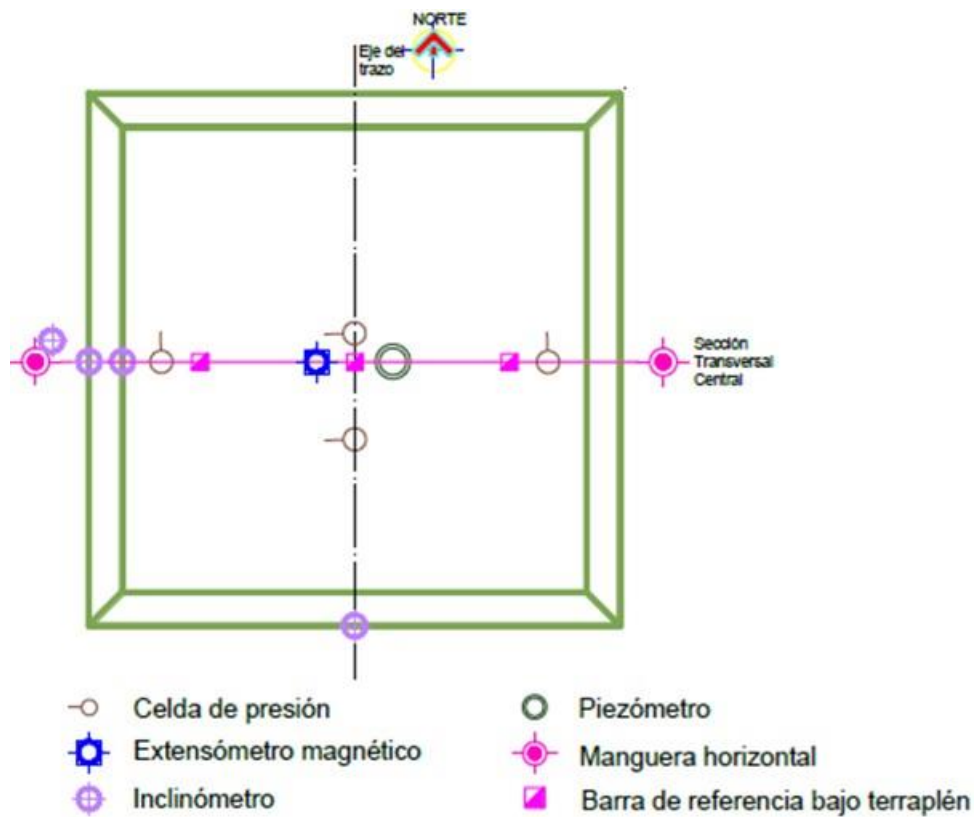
Esquema en planta de la instrumentación del TR
